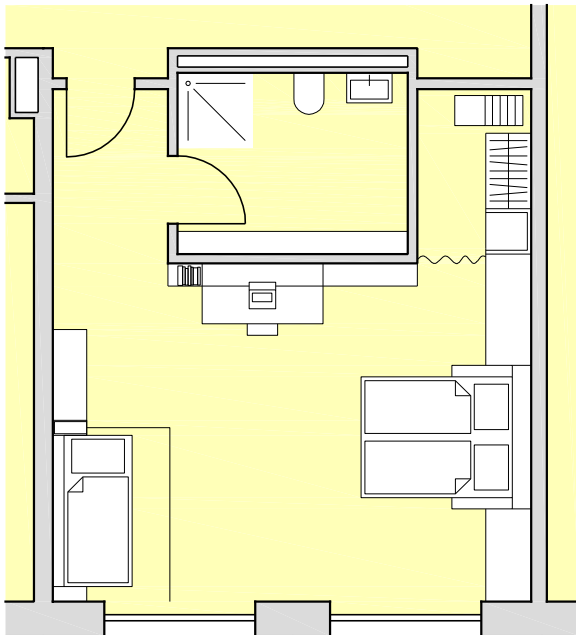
Grundriss - Doppelzimmer M 1:100
